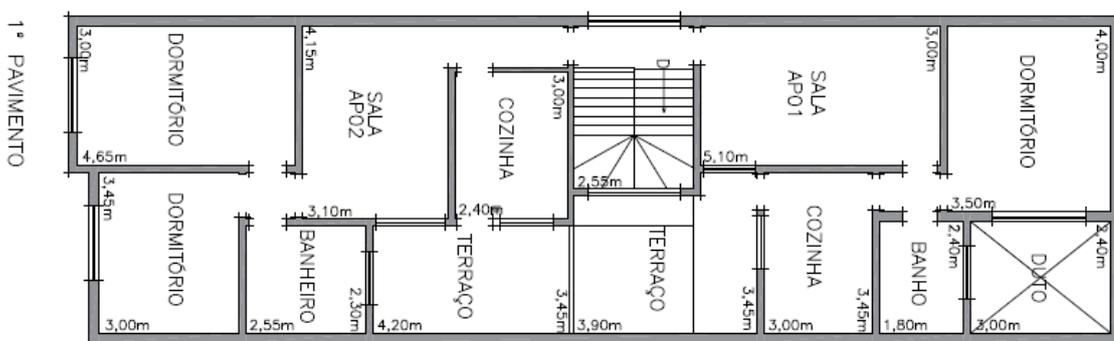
Planta baixa do primeiro pavimento composto pelos apartamentos 01 e 02. Ressalta-se que o apartamento 01 (fundo) é constituído por 01 (um) dormitório e o apartamento 02 (frente) é constituído por 02 (dois) dormitórios.
